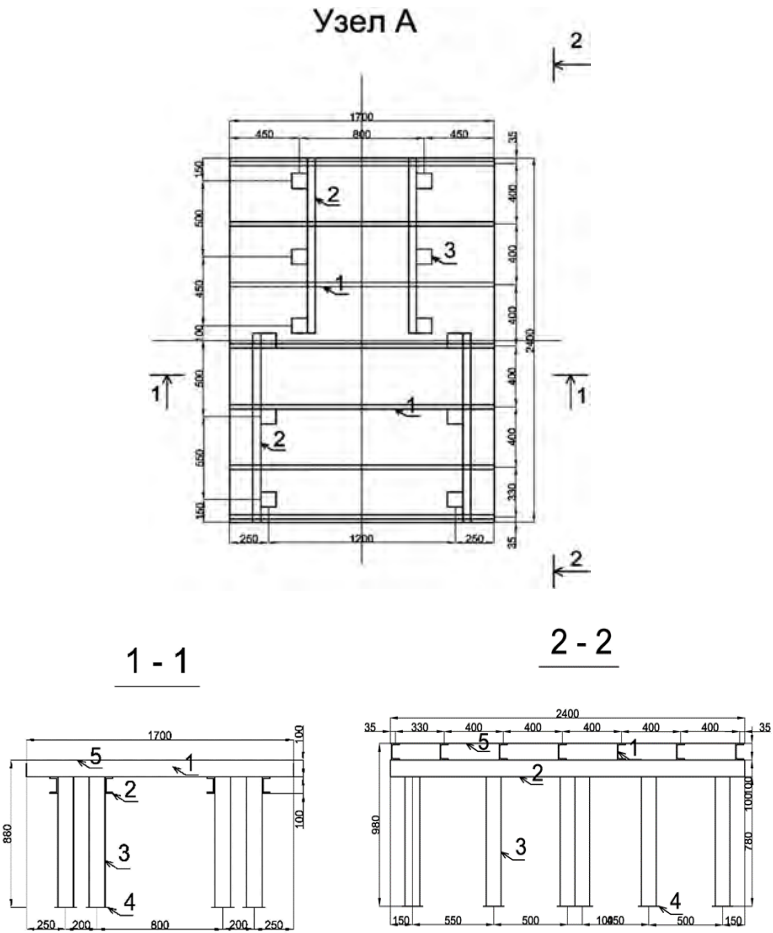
Схема площадки для монтажного оборудования в районе технологического проема
